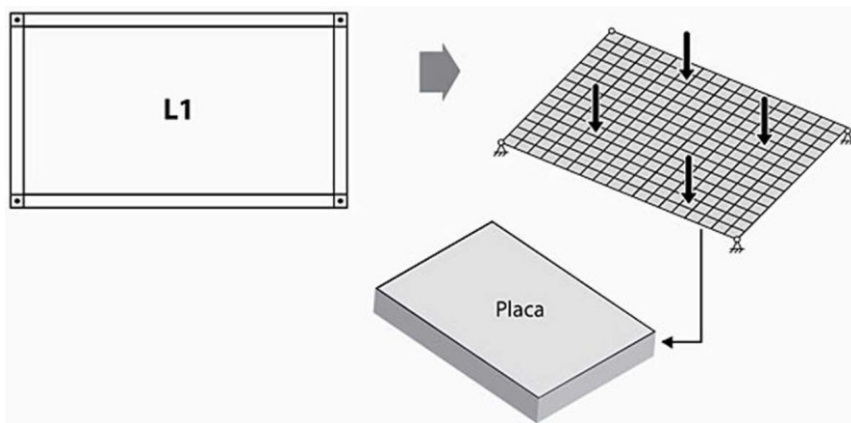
Grelha de vigas e lajes (KIMURA, 2007)
